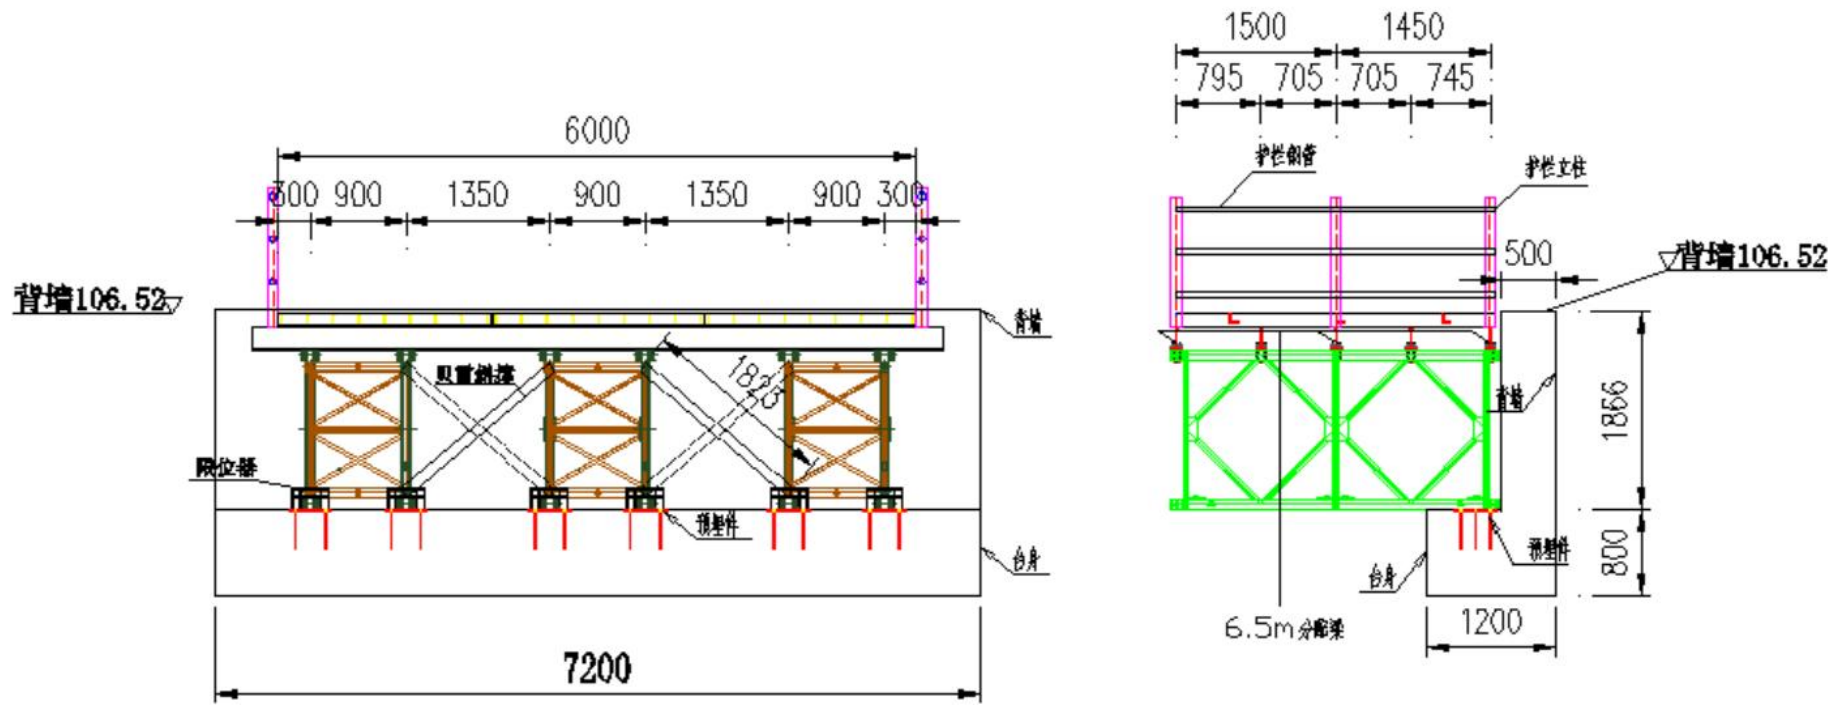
主栈桥桥台标准结构断面布置图
